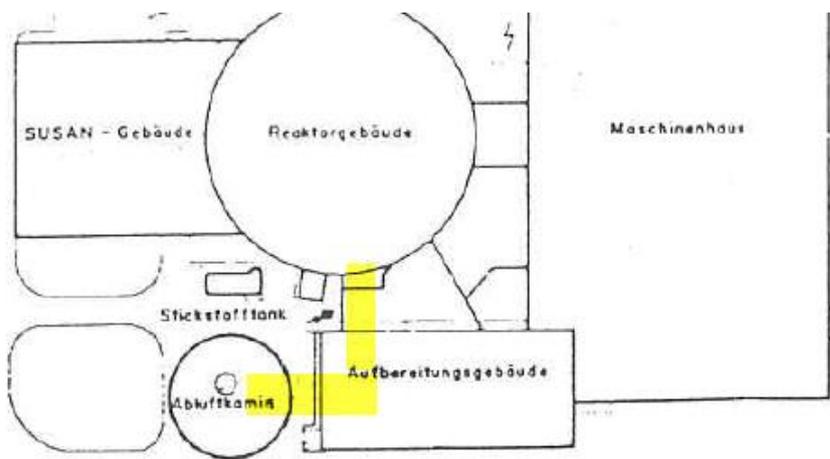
KKM Sicherheitsbericht 1989, Figur 1.2.1/12.1.1, Gesamtlageplan (Ausschnitt), 16.5.1990
